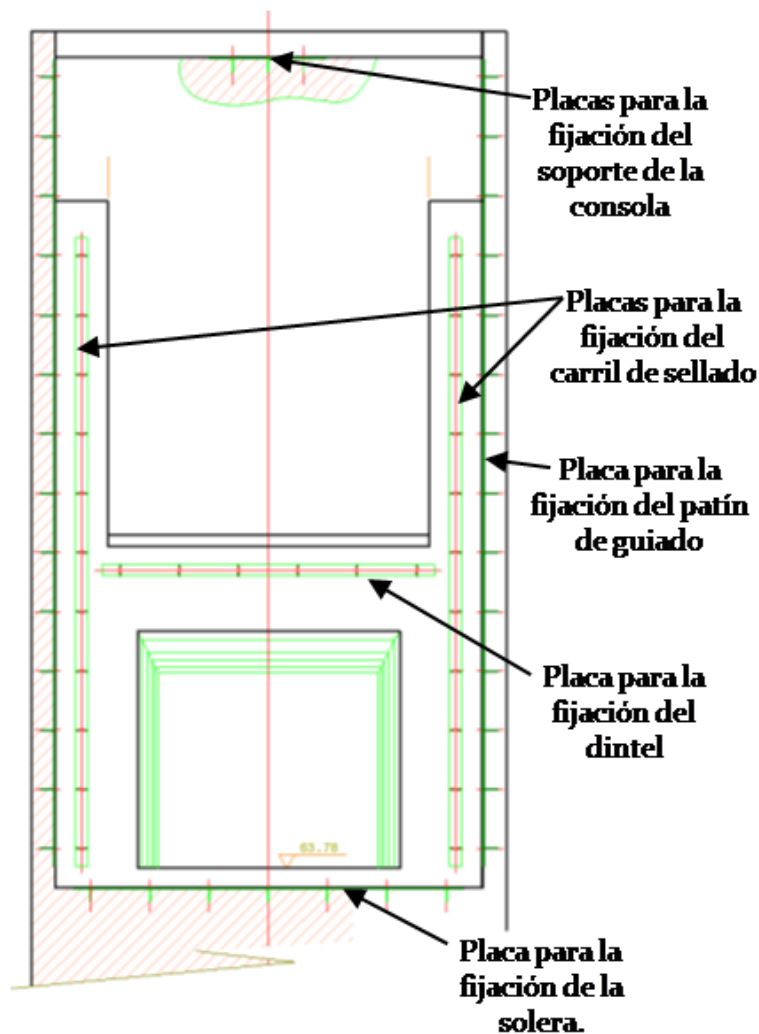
Detalle de Ubicación de las placas para los hierros fijos compuerta mural
